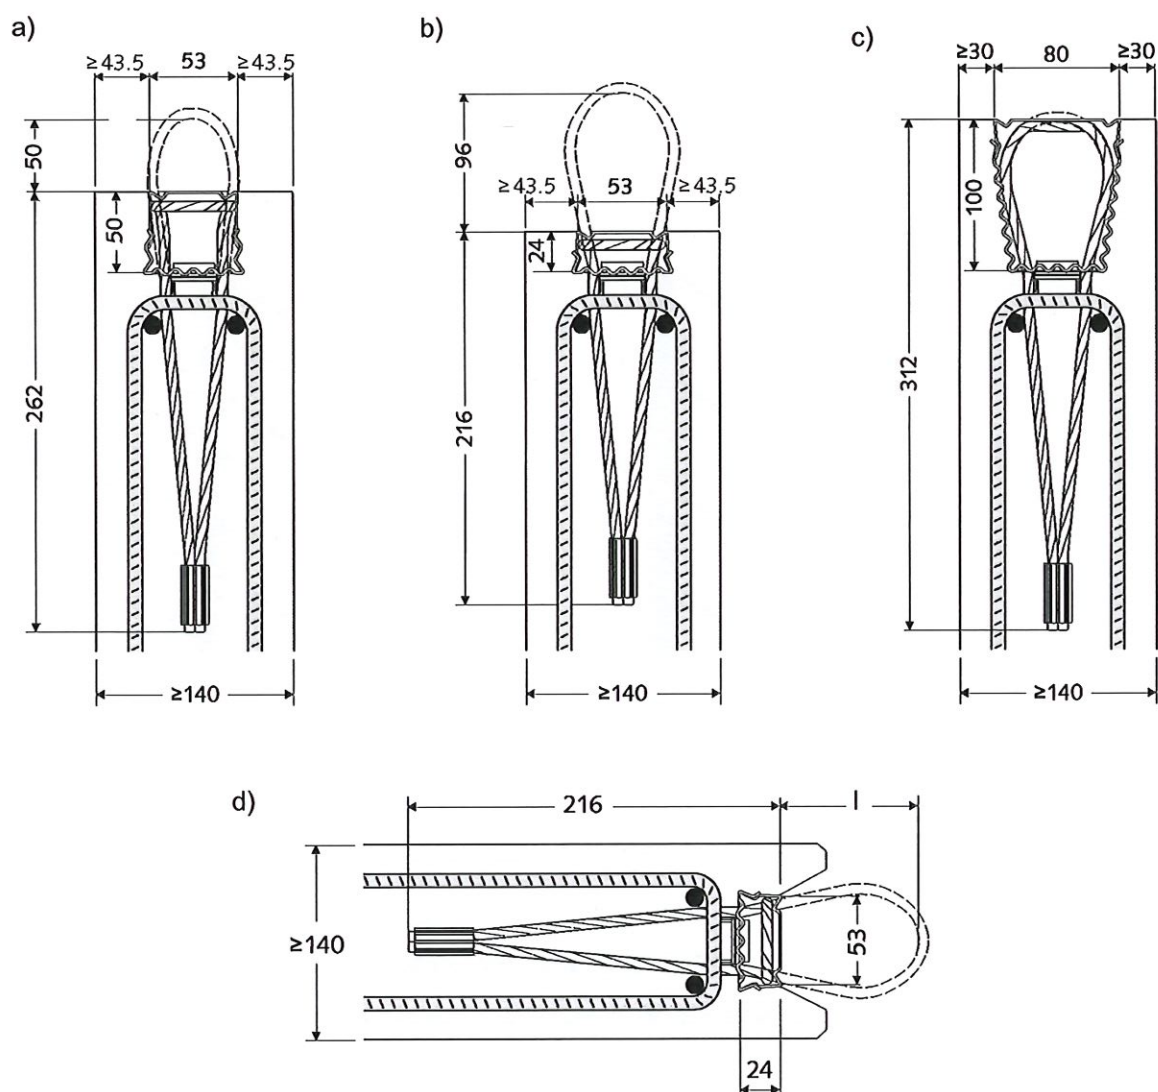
Pętlowe zestawy łączące HLB – rodzaje
